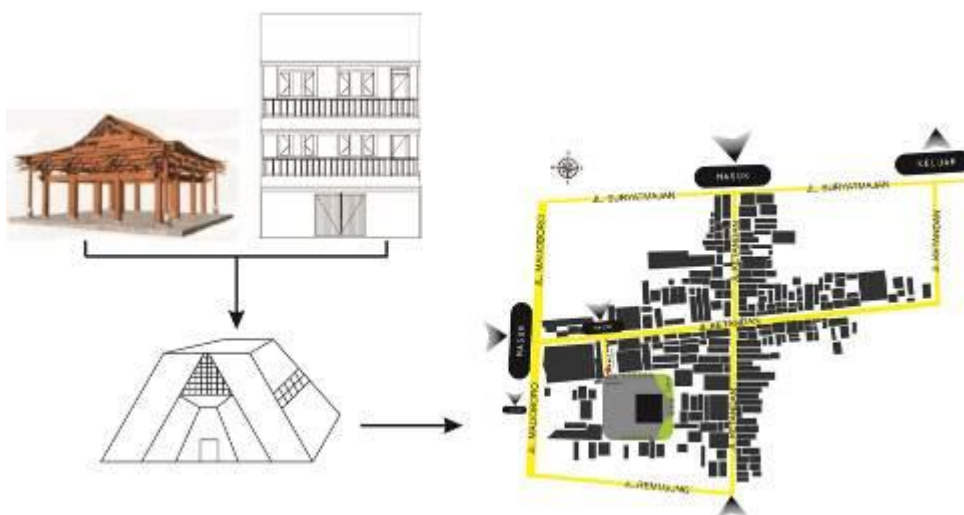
Sketsa Konsep Penampilan Massa Bangunan Baru di Pecinan Ketandan.
